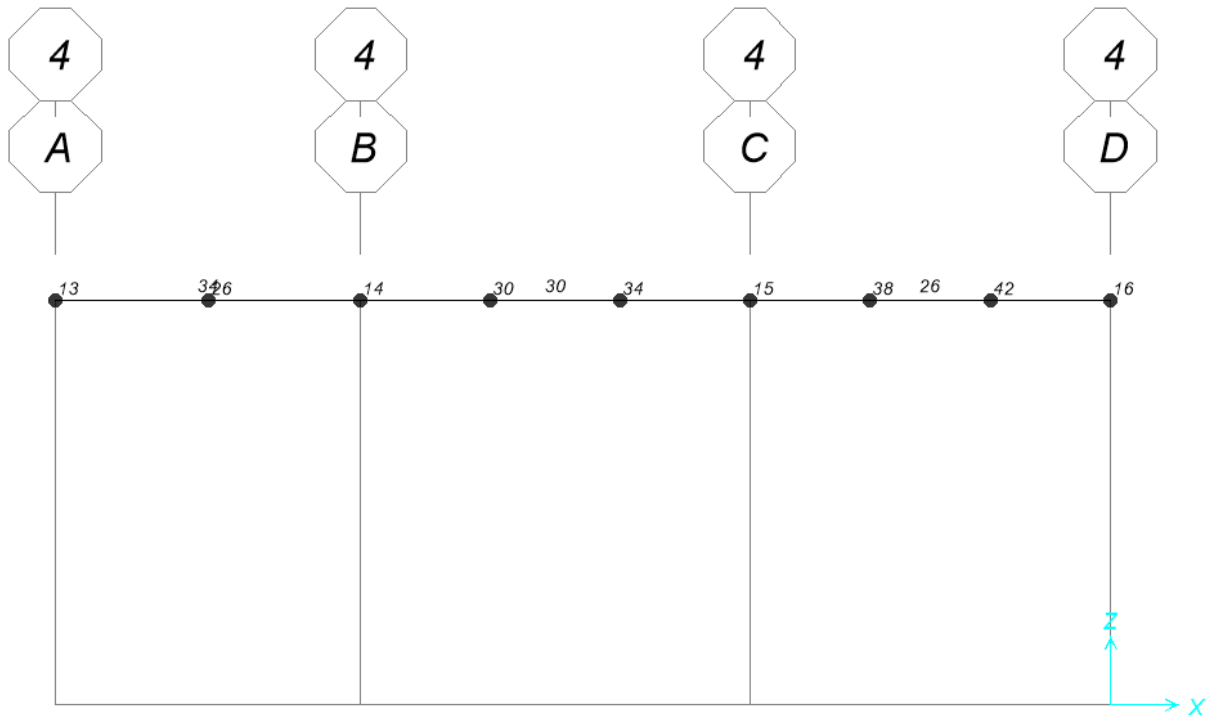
Vista in sezione modello struttura in elevazione –Filo 4 - numerazione elementi frame e joint
